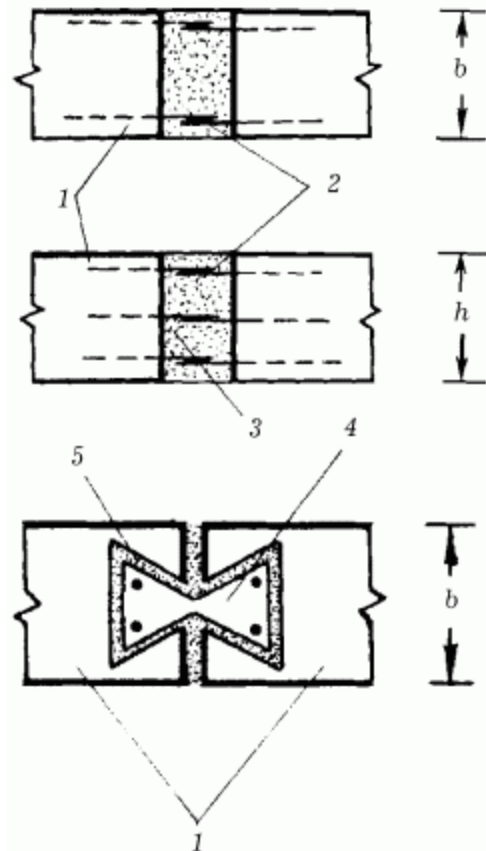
Устройство ленточного фундамента на средне-и сильно-пучинистых грунтах: 1 – блоки; 2 – арматура; 3 – бетон; 4 – железобетонная шпонка; 5 – раствор.
